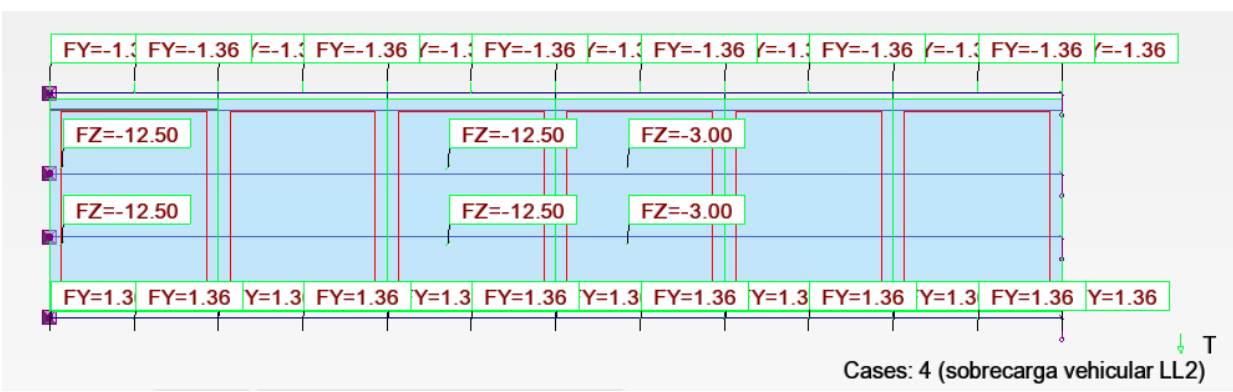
Vista en planta - Carga tipo MOP MODIFICADA
